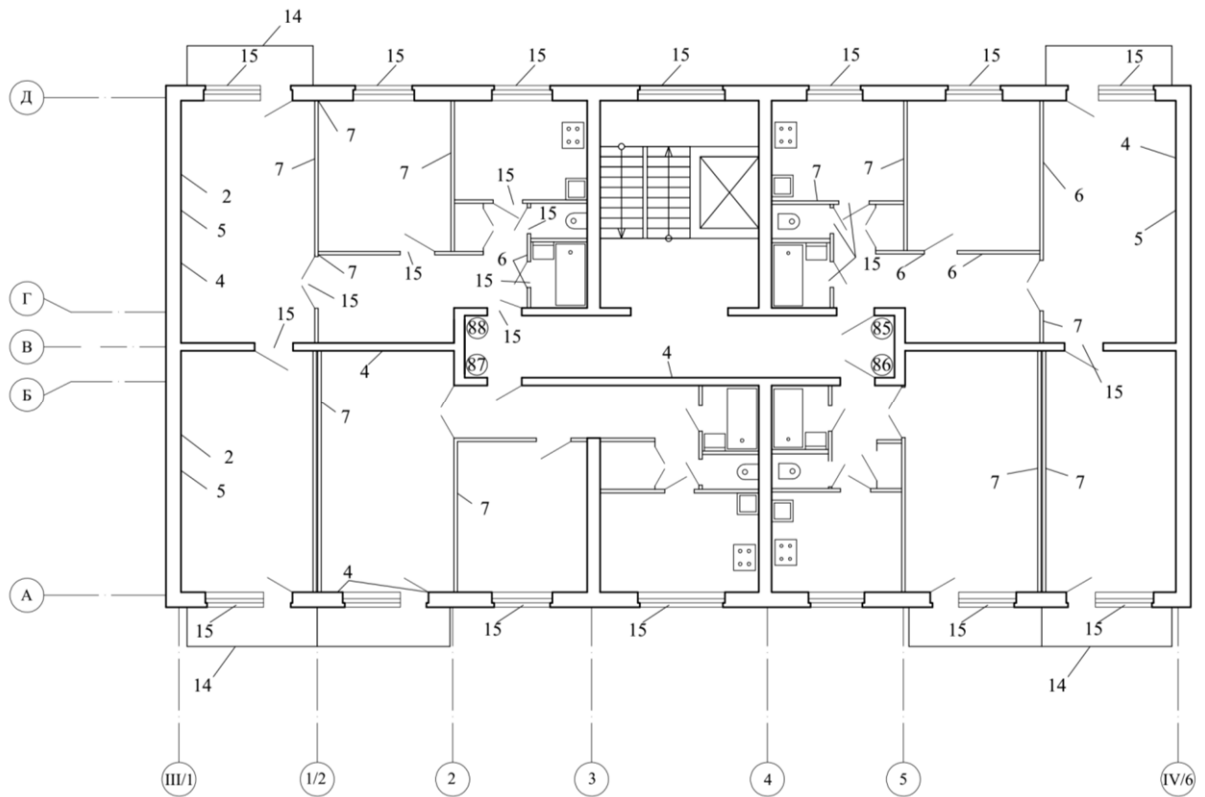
План четвертого поверху блок-секції № 3 будівлі
